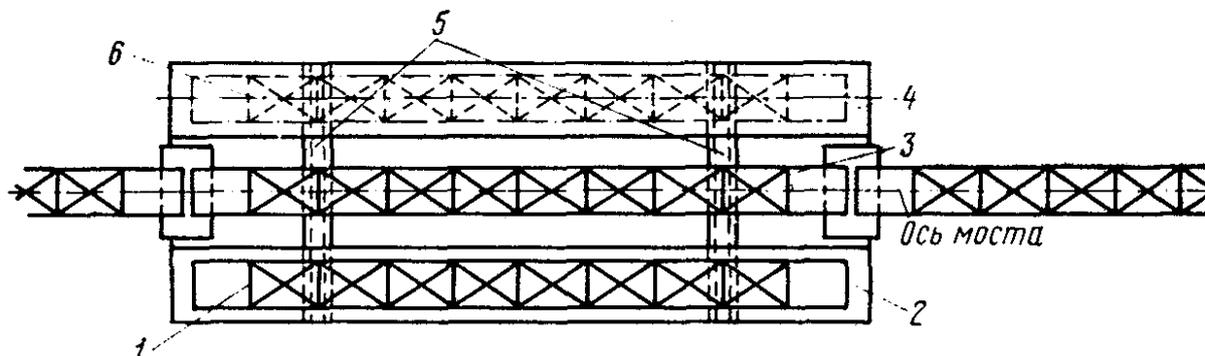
Схема поперечной передвижки при замене пролетных строений:
